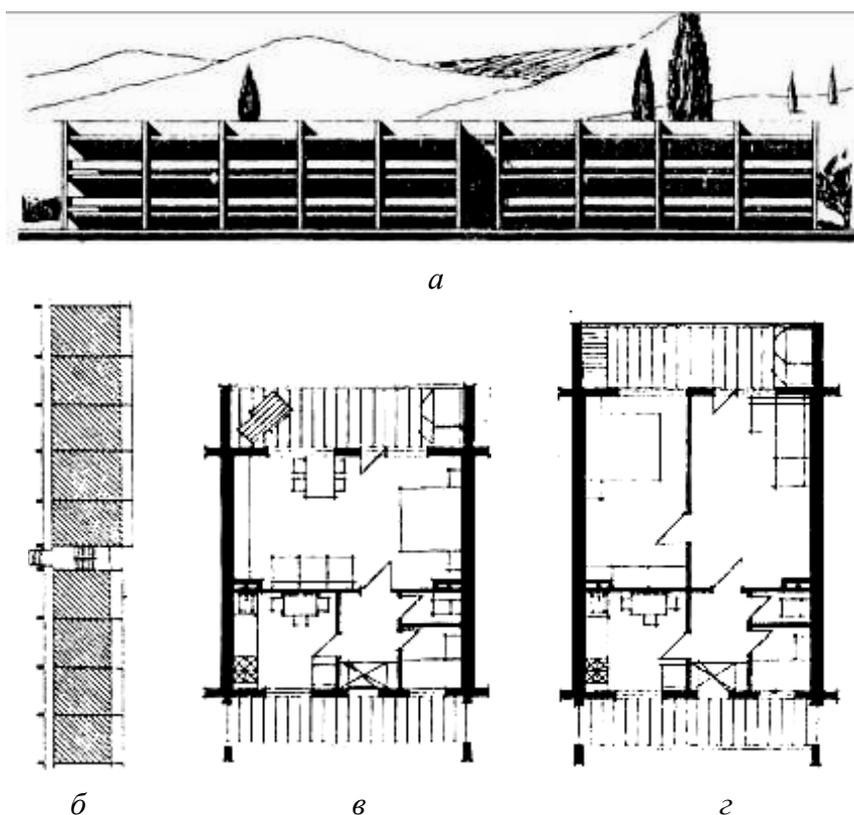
Жилой дом галерейного типа с галереями в каждом этаже: *а* — общий вид; *б* — план этажа; *в* — план однокомнатной квартиры; *г* — план двухкомнатной квартиры
